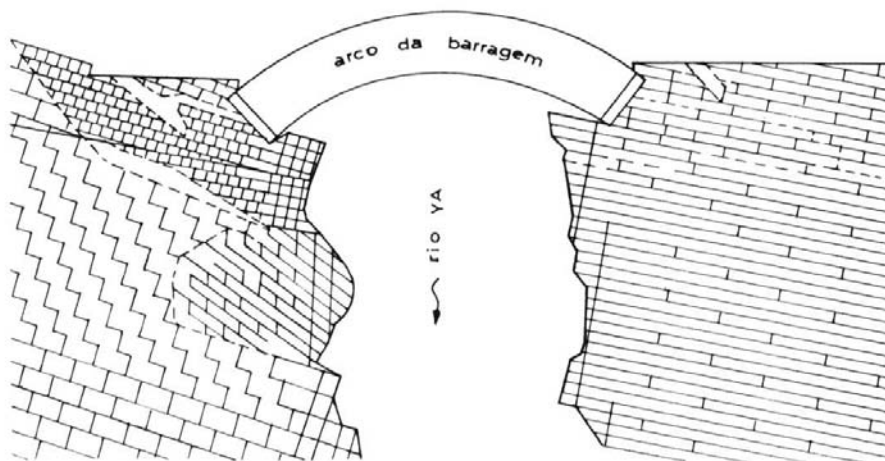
Modelo geomecânico plano da barragem de Er
